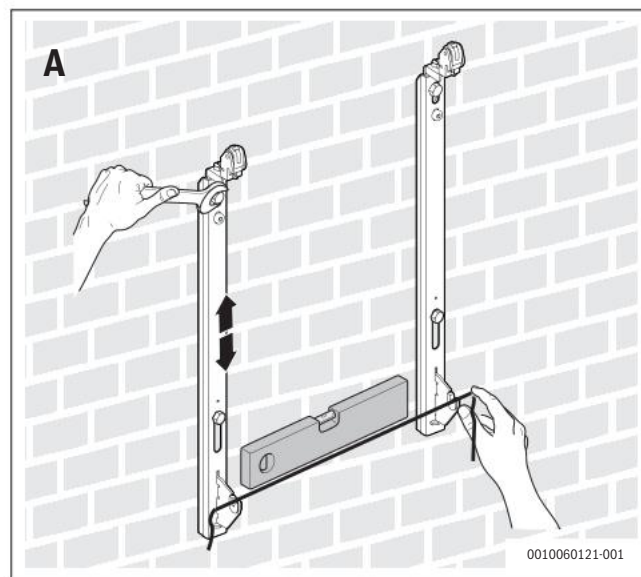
Fissaggio dei supporti alla parete (cont.)
